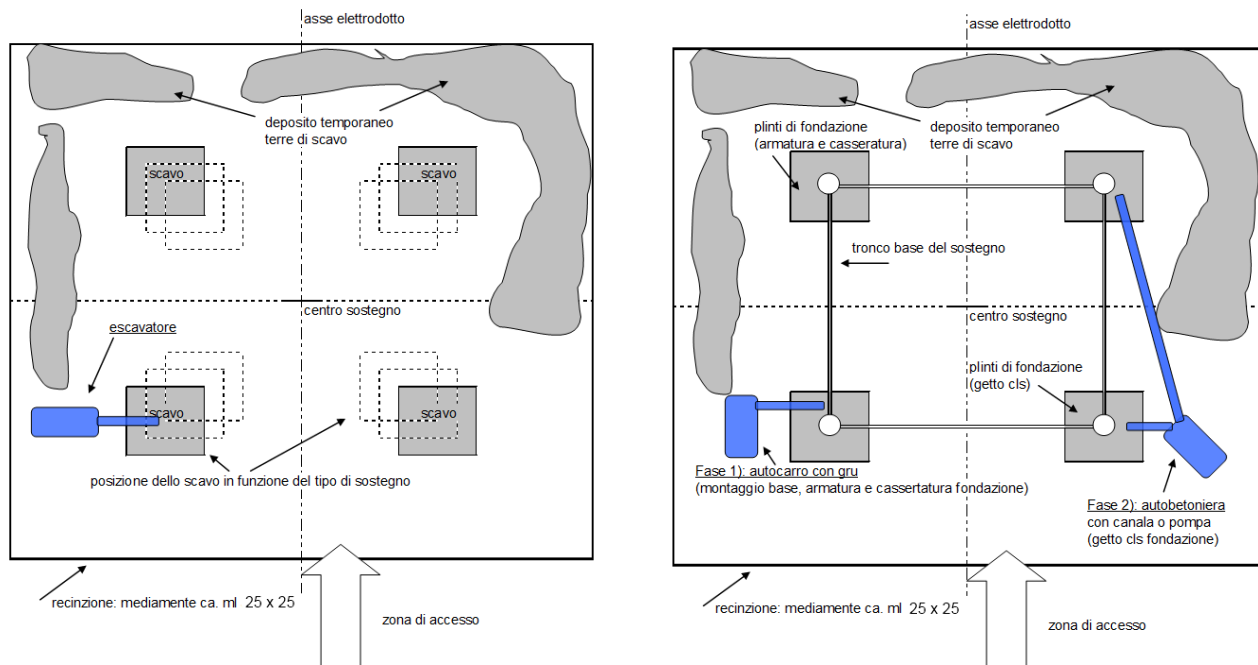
Planimetria dell'Area Sostegno (scavo di fondazione - getto e basi) - Tipologico
